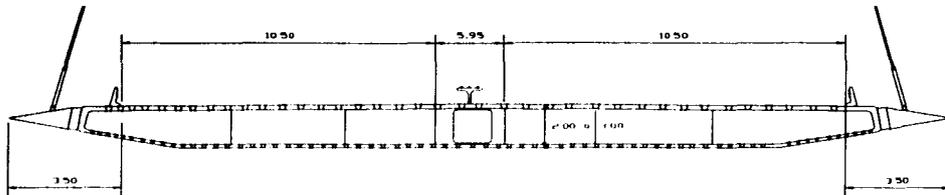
Sección transversal Danesa, adecuada para claros grandes
